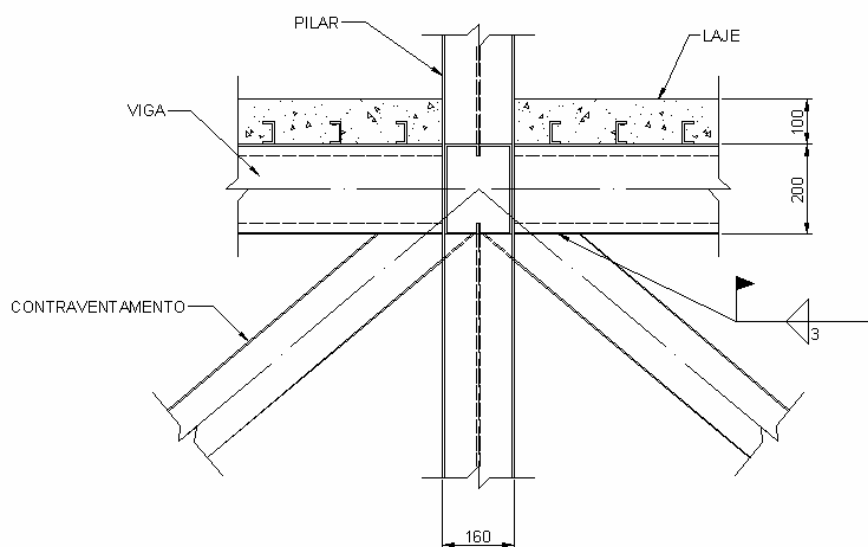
Detalhe construtivo da ligação Contraventamento – Estrutura [3]
